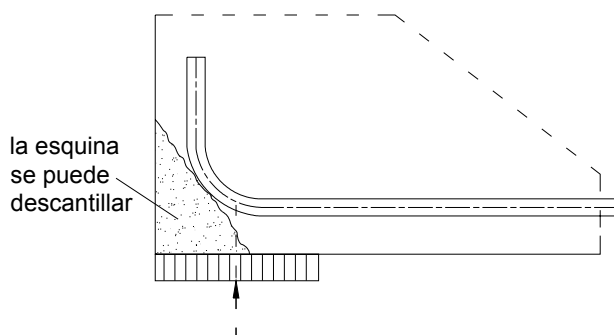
Gancho normal en un apoyo directo en el extremo de una viga
